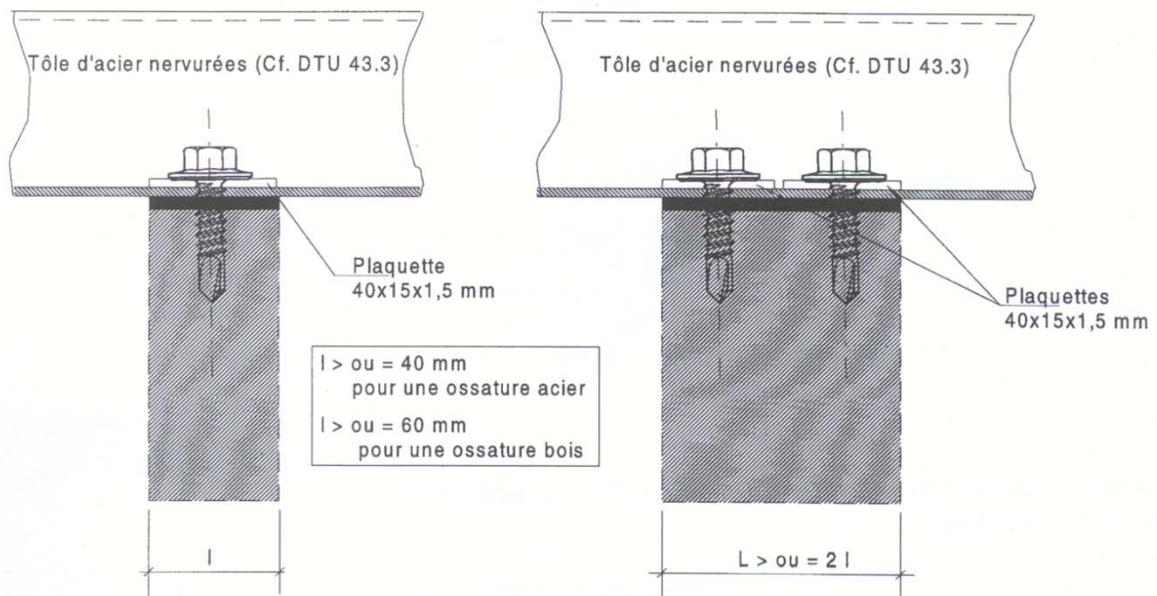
Dispositions pour fixation de la tôle d'acier nervurée à l'ossature, par 1 ou 2 fixations par nervure
